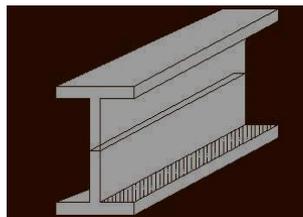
Perfil en doble T (www.ConstruAprende.com)
